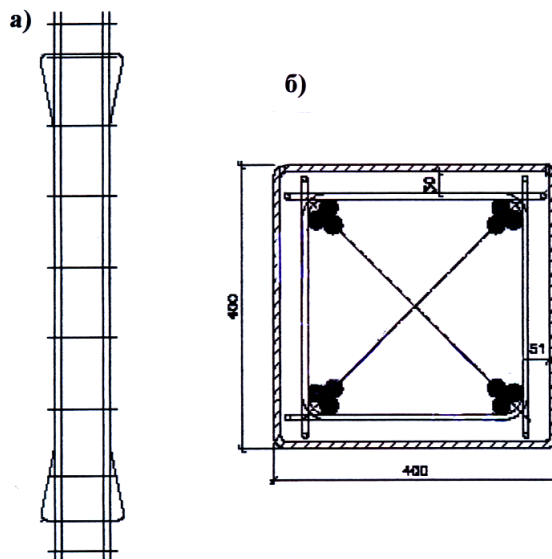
Арматурный каркас (а) и поперечное сечение (б) трубобетонной колонны квадратного сечения многоэтажного здания [14]
